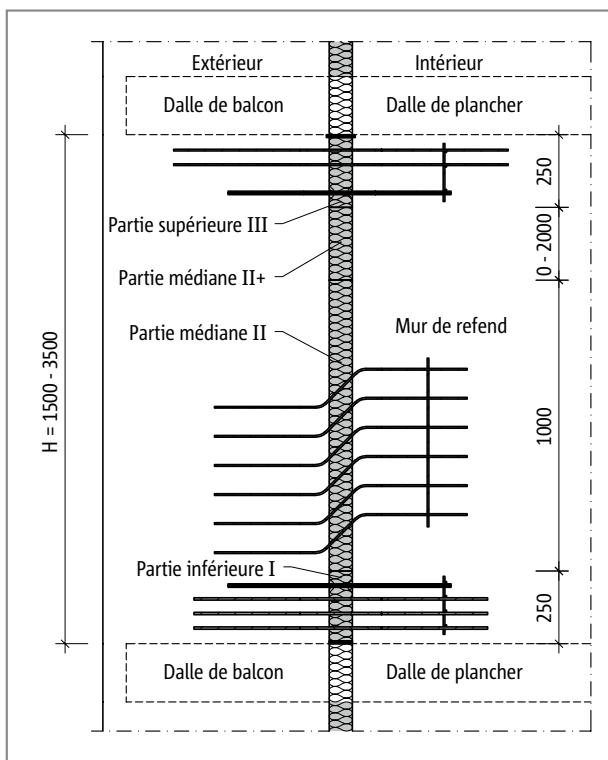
Schöck Isokorb® T Type W : Construction de balcon avec murs de refend porteurs isolés thermiquement
